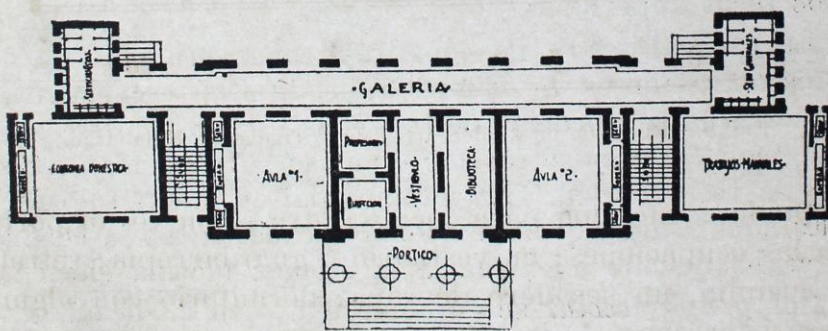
Plano de un kindergarten proyectado por la Secretaría de Instrucción Pública de Cuba.
